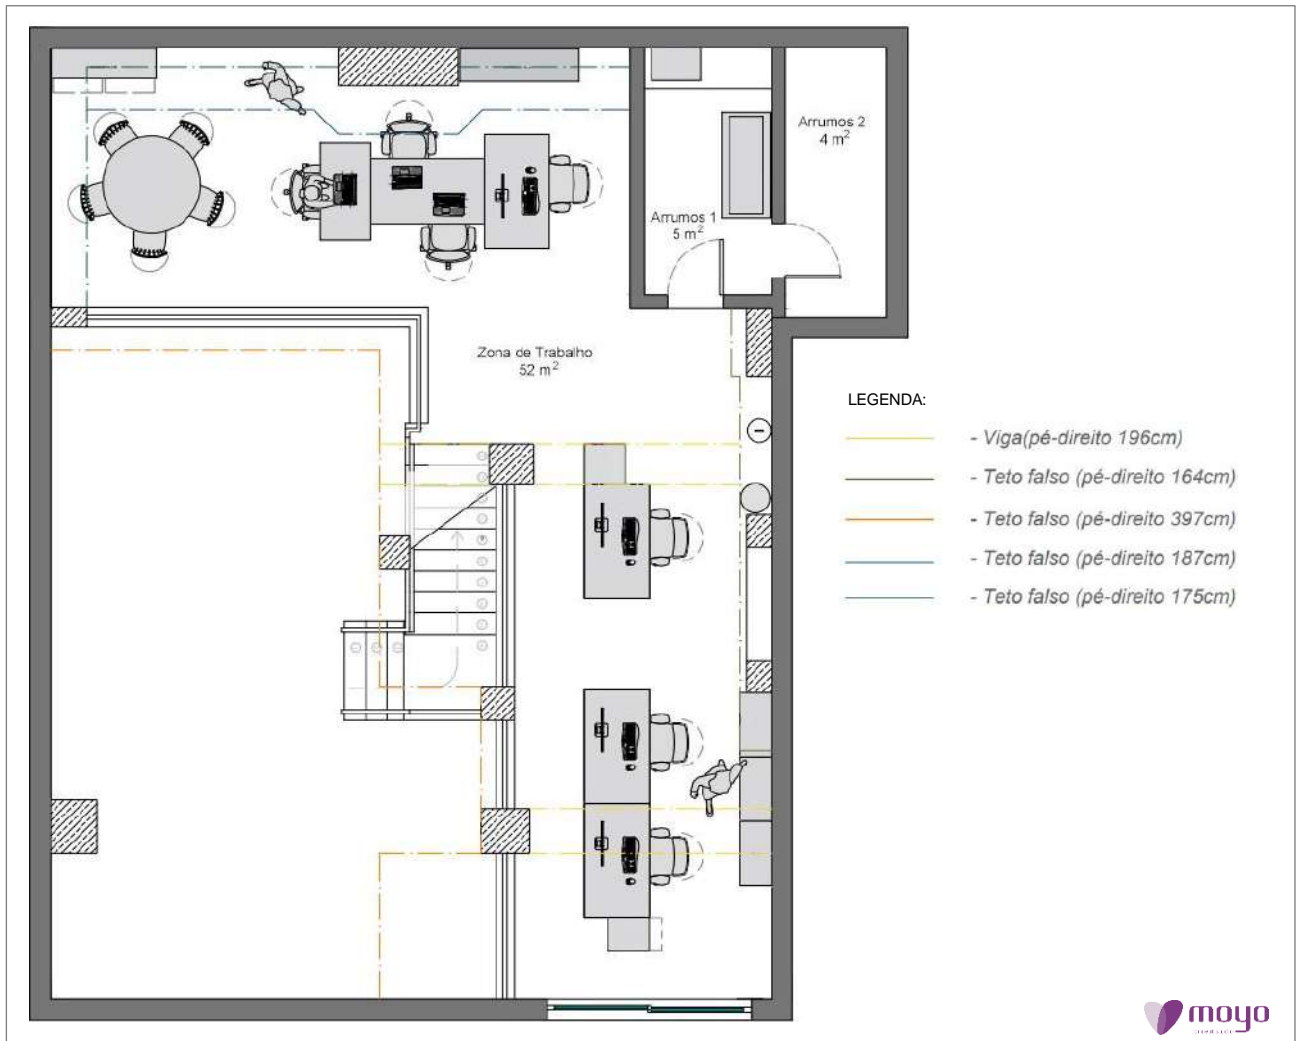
Layout Final Loja Moyo (Piso 1) - Disposição 2
